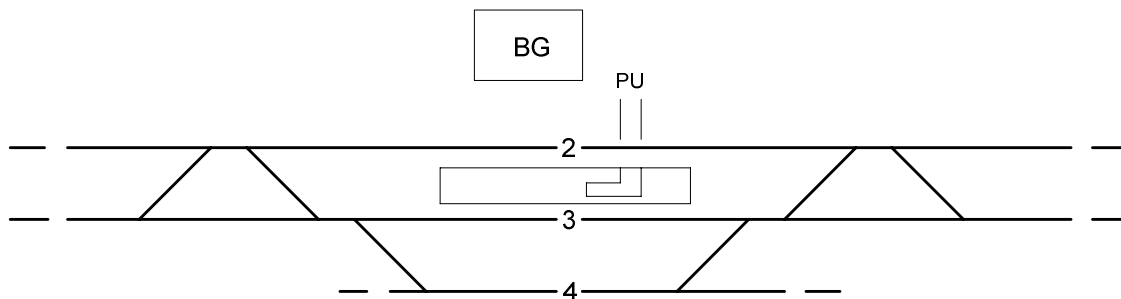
Bahnhof mit drei Gleisen und schienenfreien Zugängen (Gleis 1 rückgebaut oder wird später nachgebaut)
